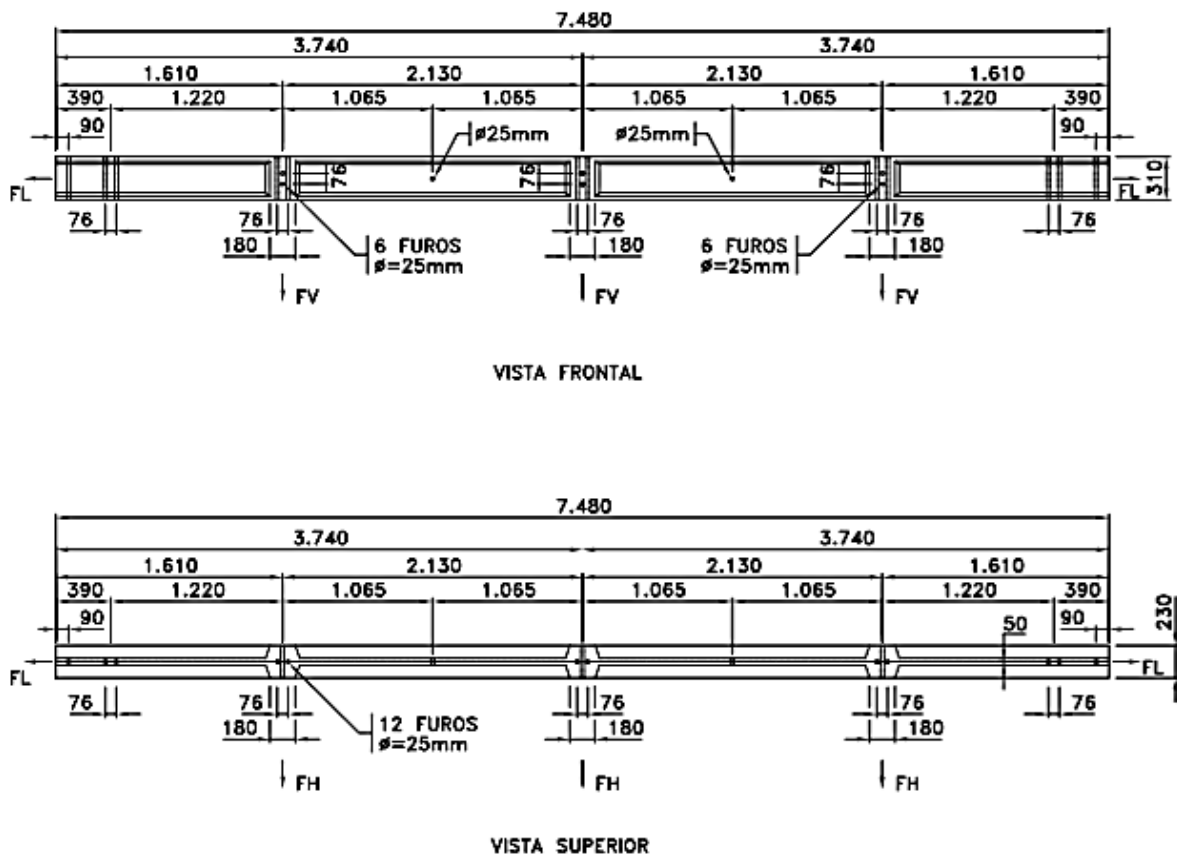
Viga de Concreto armado de 230x310x7.480mm, montagem vertical
